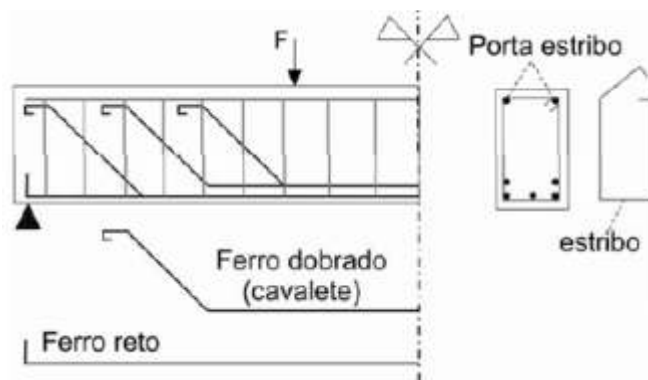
Armaduras longitudinal (reta + dobrada) + armadura transversal (estribo) (MARINS *et al.*, 2001).
